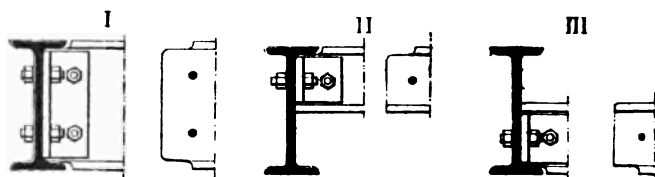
à 721. — Assemblage de solives égales et inégales.
